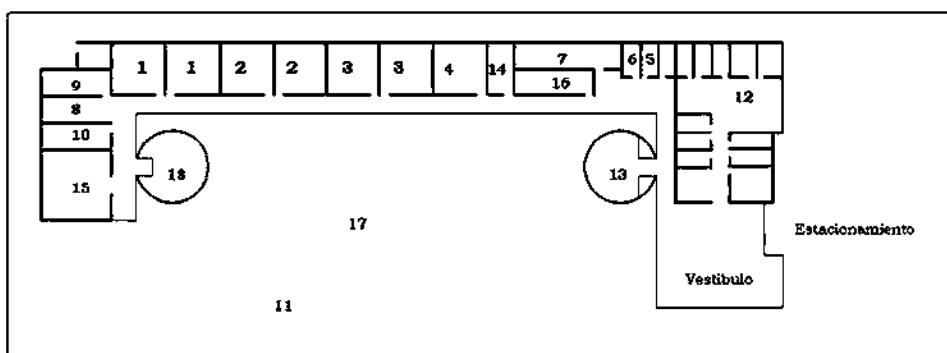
Planta Arquitectónica CAT. Realizado por la autora
